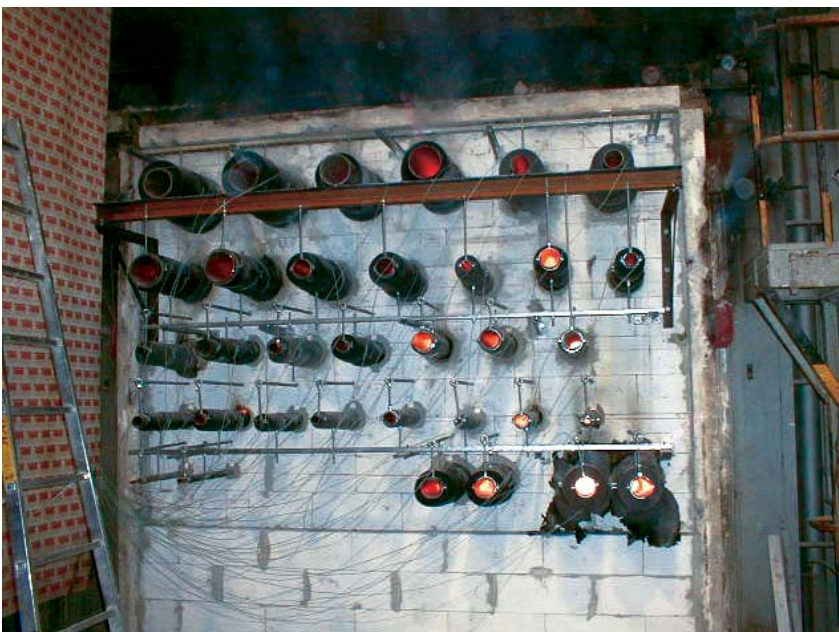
Prüfaufbau: Wanddurchführungen (Werkbild Armacell)
